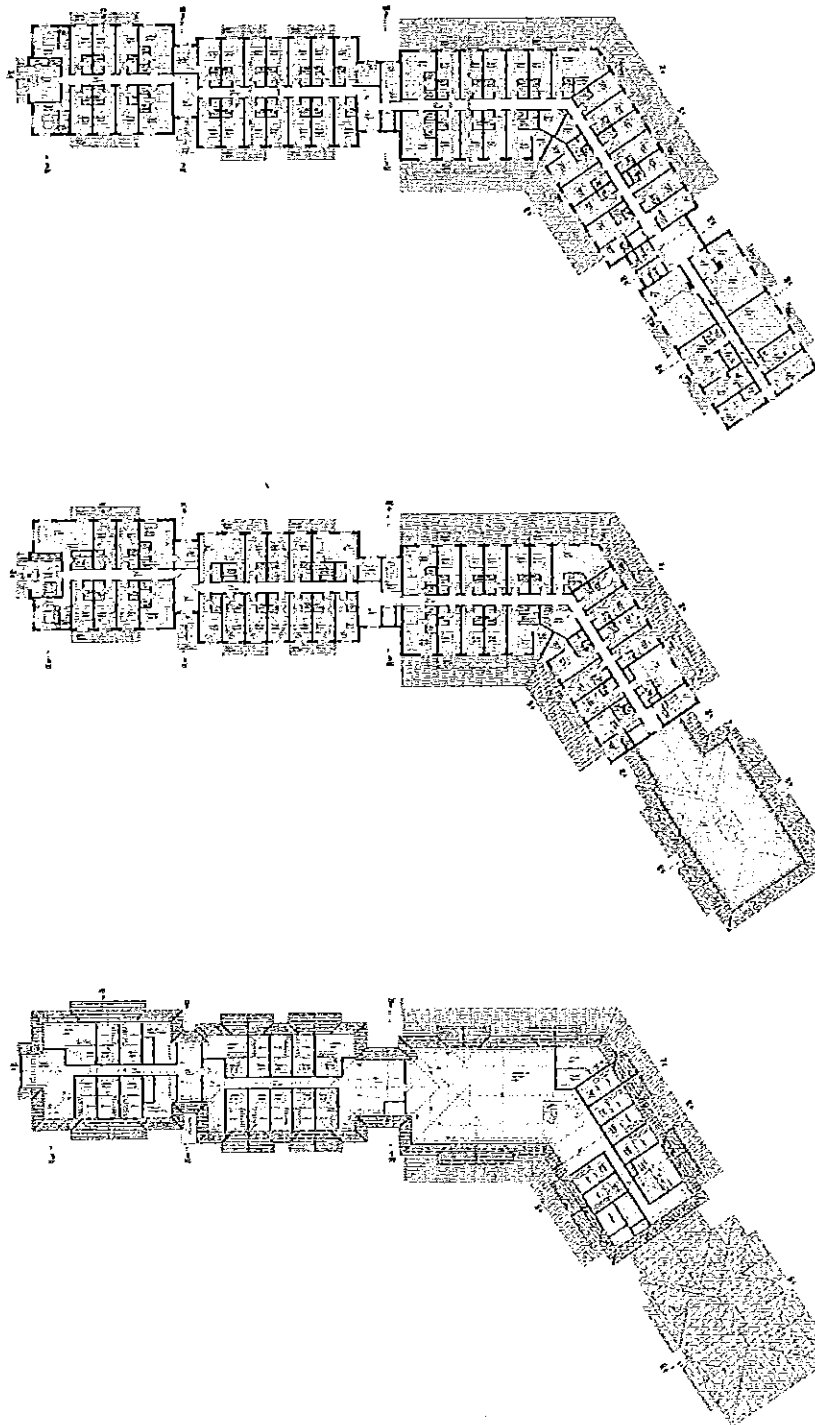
Dachaufsicht Hotel Beach Motel Heiligenhafen
